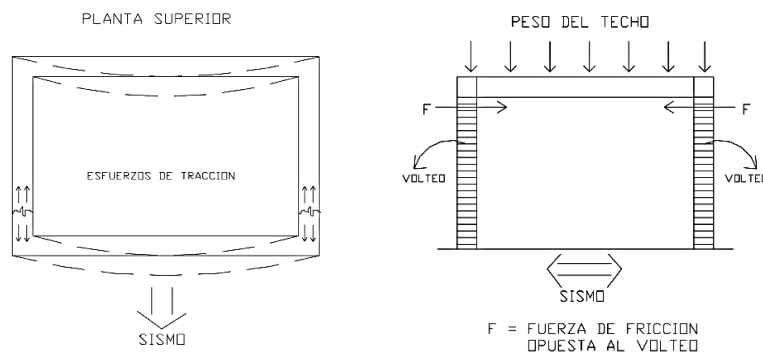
Fisuras verticales en esquinas y volteo del muro fuera del plano.
